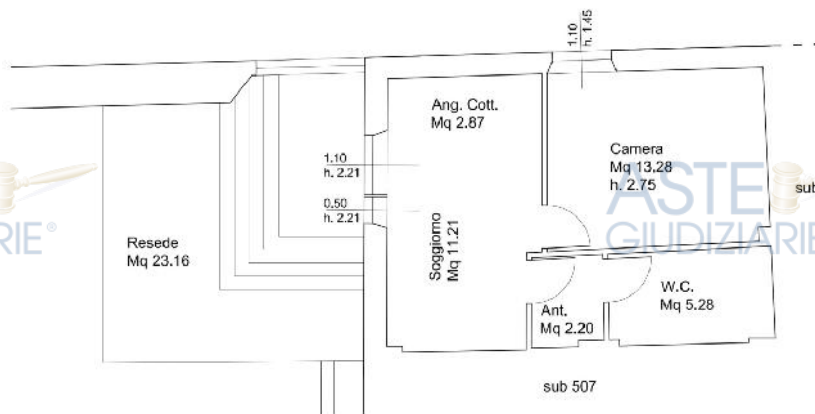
Planimetrie dello stato attuale Piano Terra
